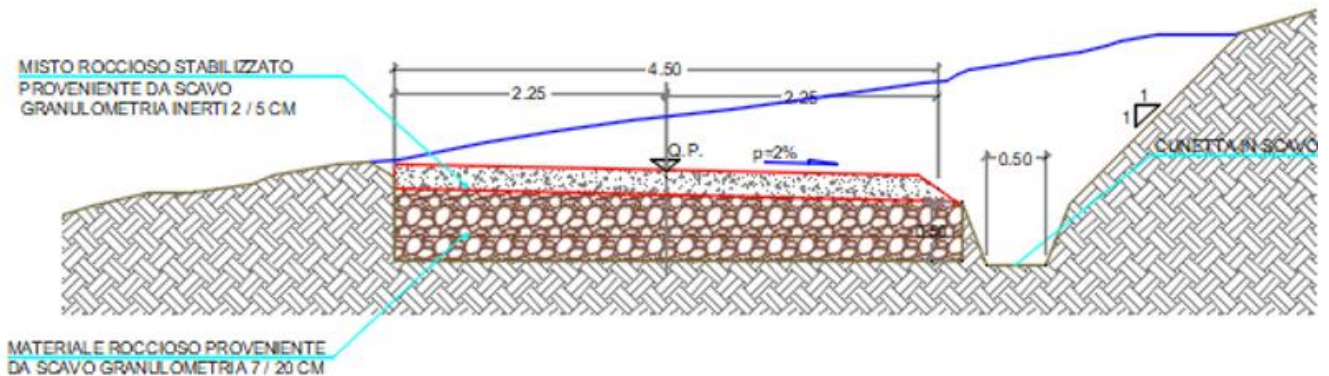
Sezione stradale "tipo" IN SCAVO della viabilità di progetto
